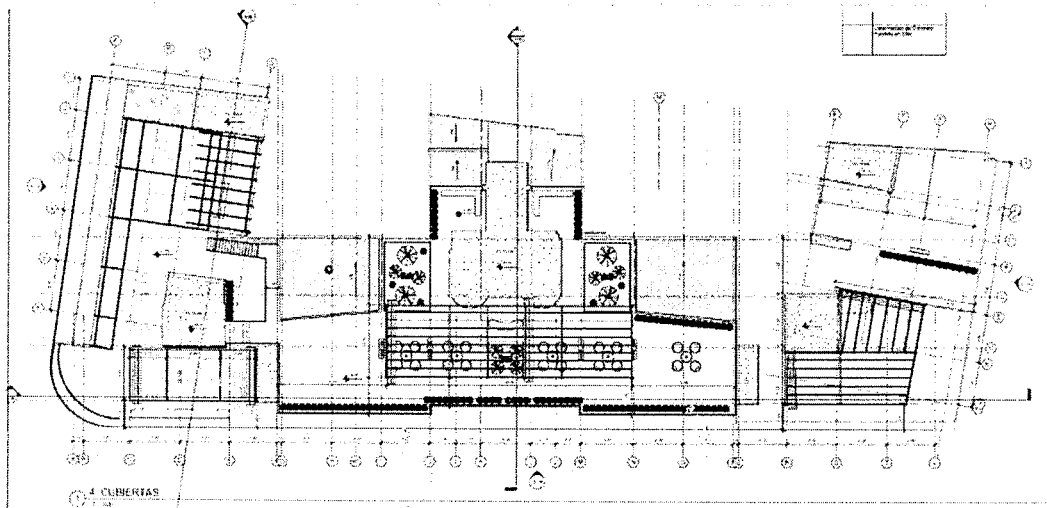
/ planta de cubiertas indica que las pérgolas se retroceden lo suficiente del plano de fachada
